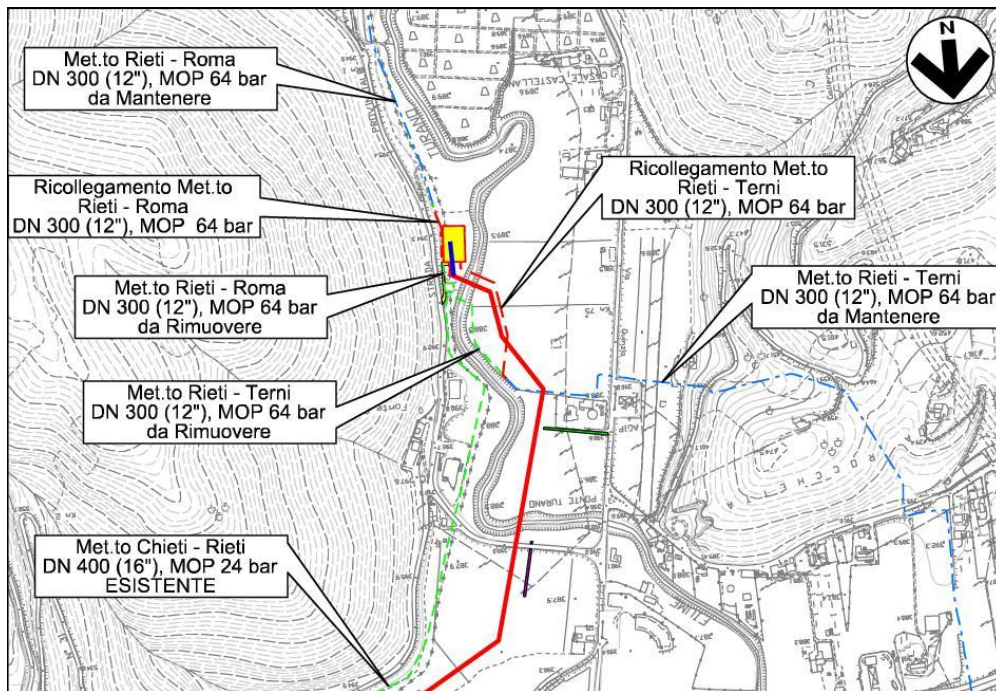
Planimetria con visualizzata la Variante n. 14.
